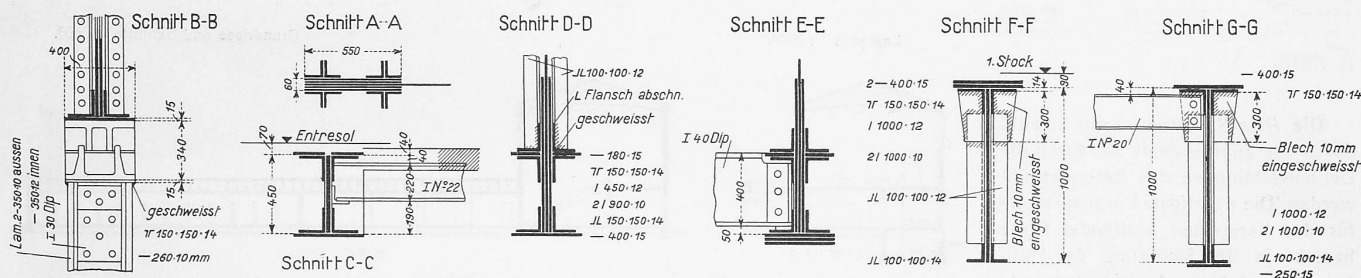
Schnitte zu Abb. 8. — Masstab 1 : 40.
